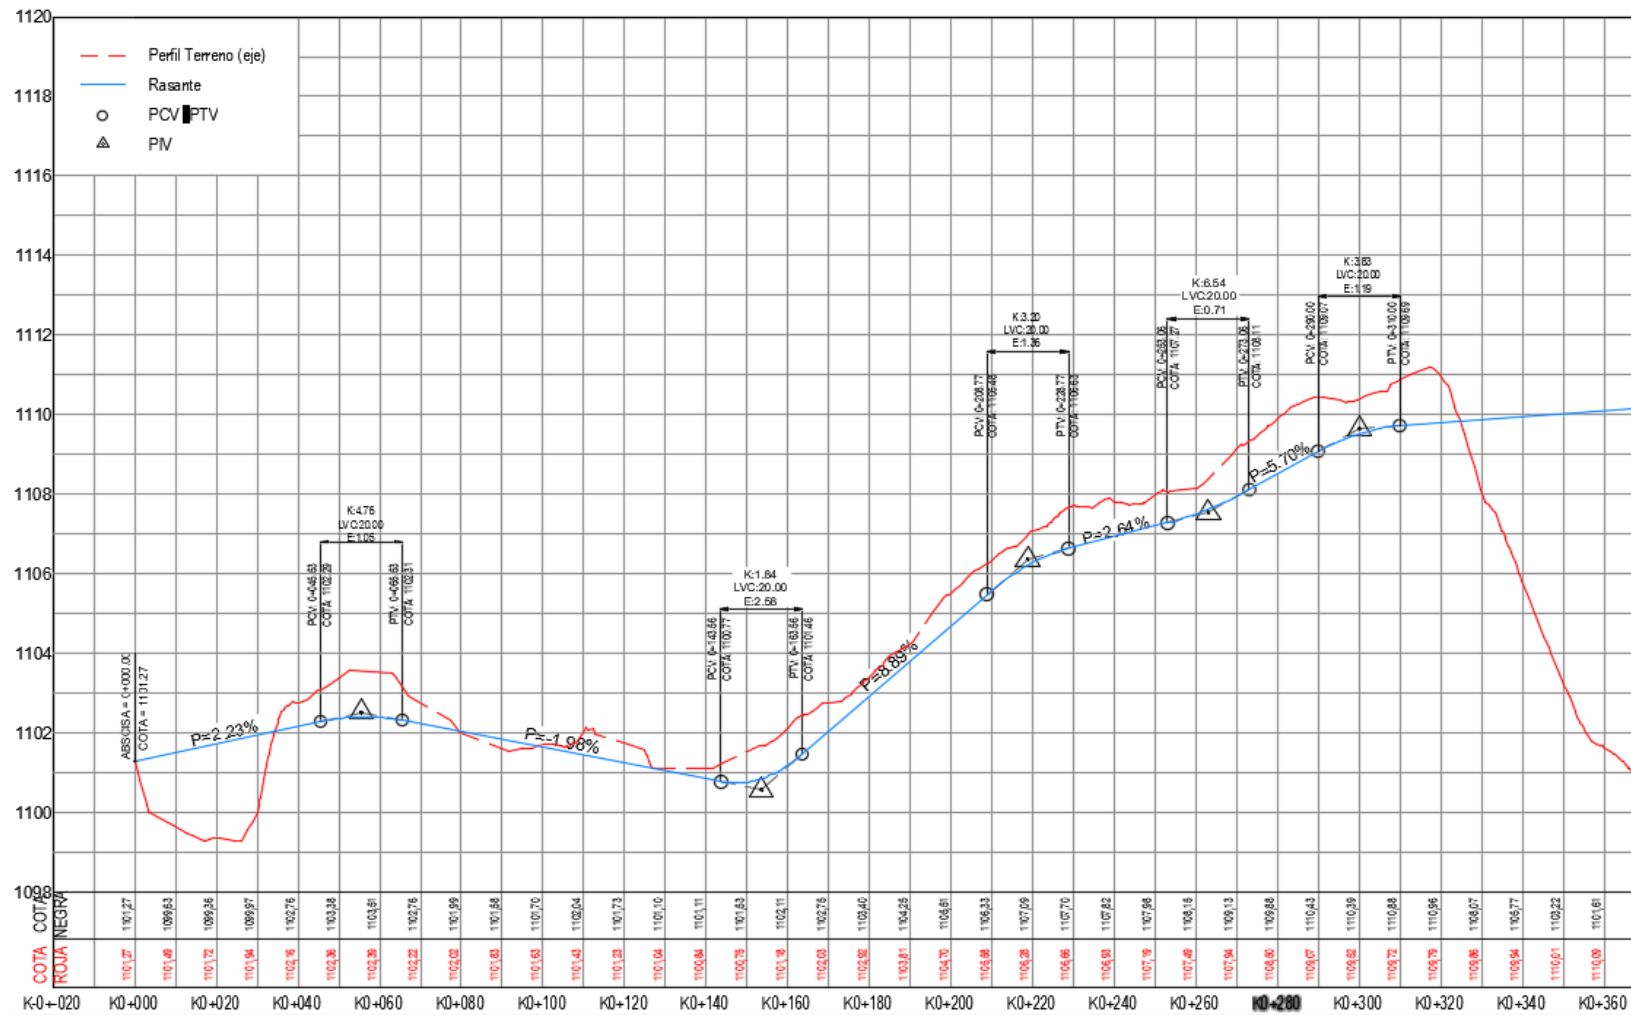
Perfil vía a casa de máquinas K0+000 a K0+360
